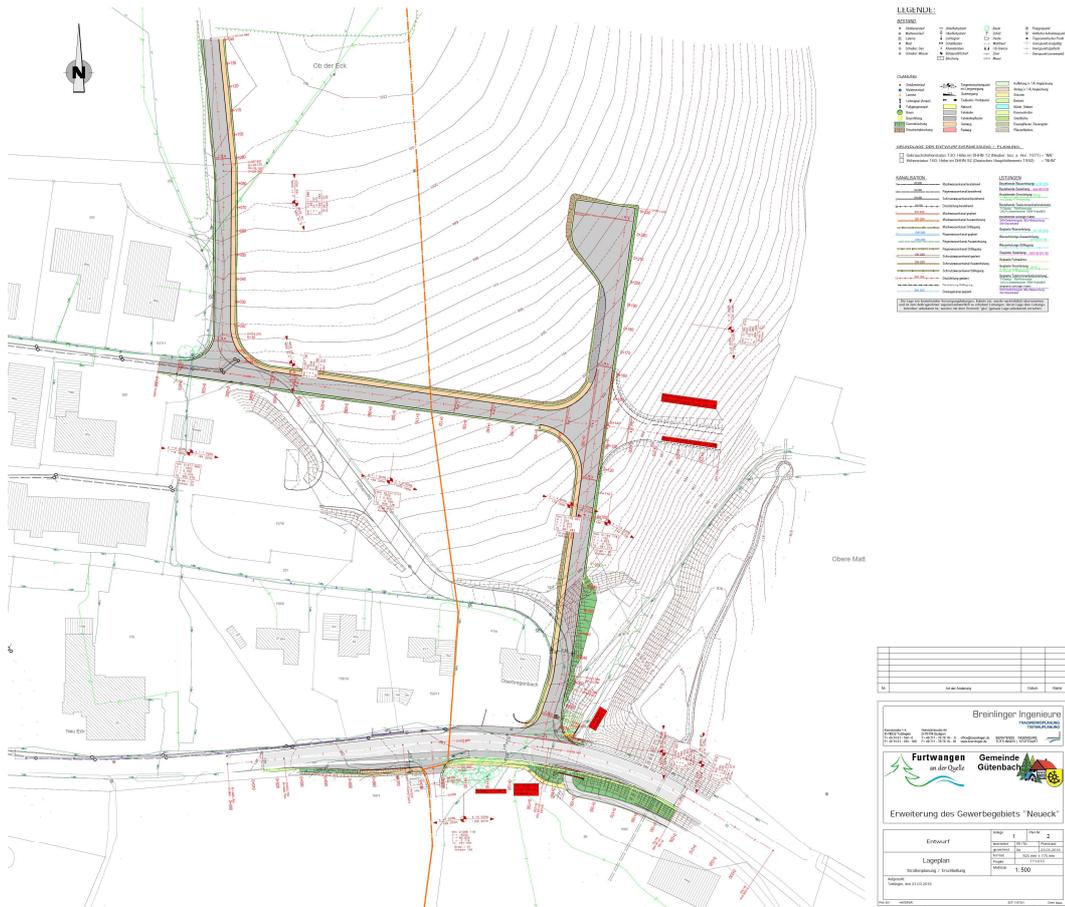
Straßenplanung/ Erschließungsplanung Schmutzwasser, IB Breinlinger, Planstand 26.04.2016
